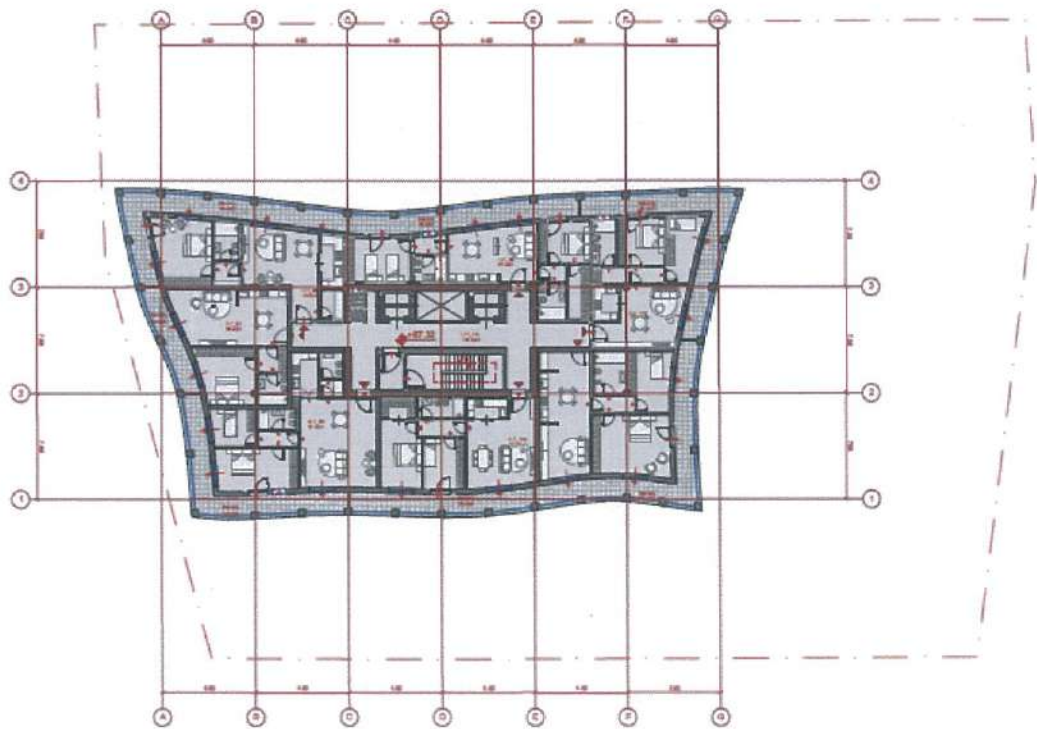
Planimetria e katit 17, në kuotën +67.32 SIP 932 m²
